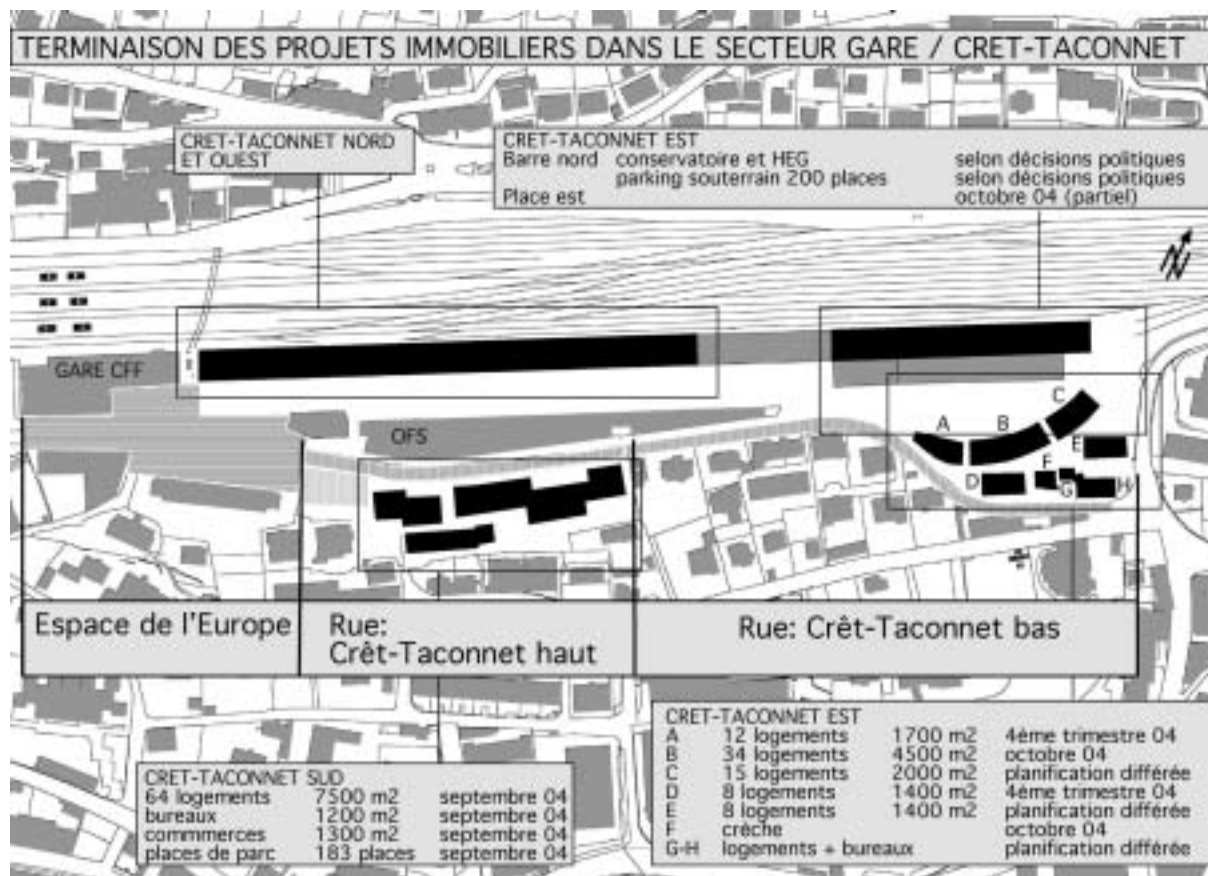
Plan du secteur Gare / Crêt-Taconnet
